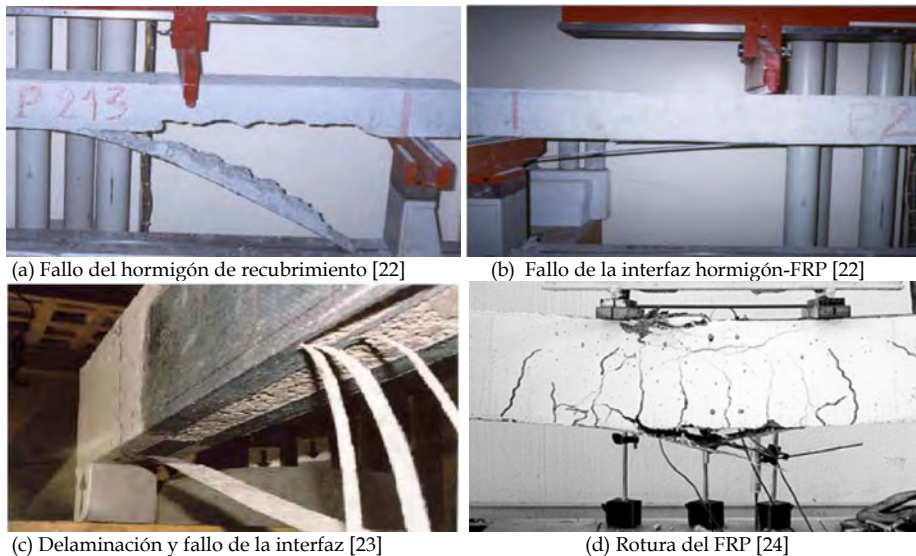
ALGUNOS FALLOS EN LAS VIGAS REFORZADAS CON FRP
